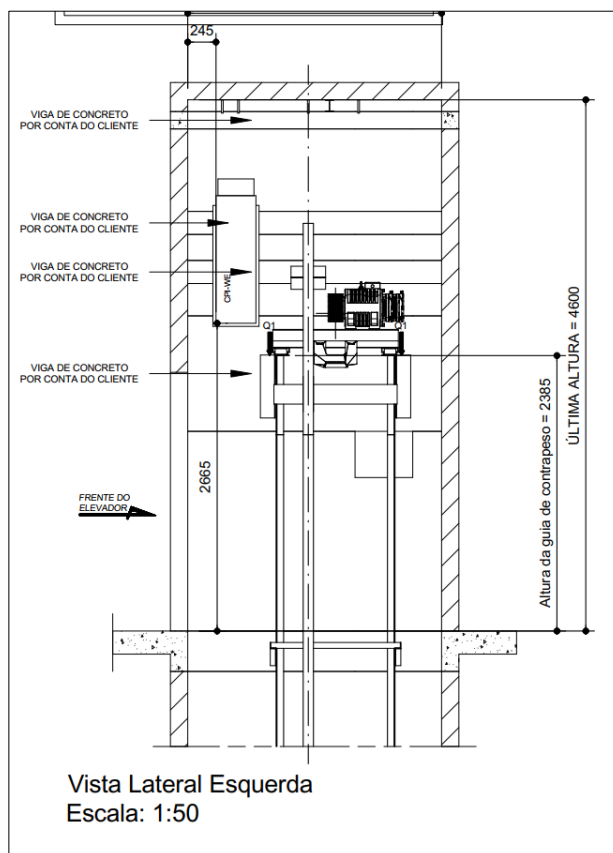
Exemplo de novas vigas para fixação do elevador.
